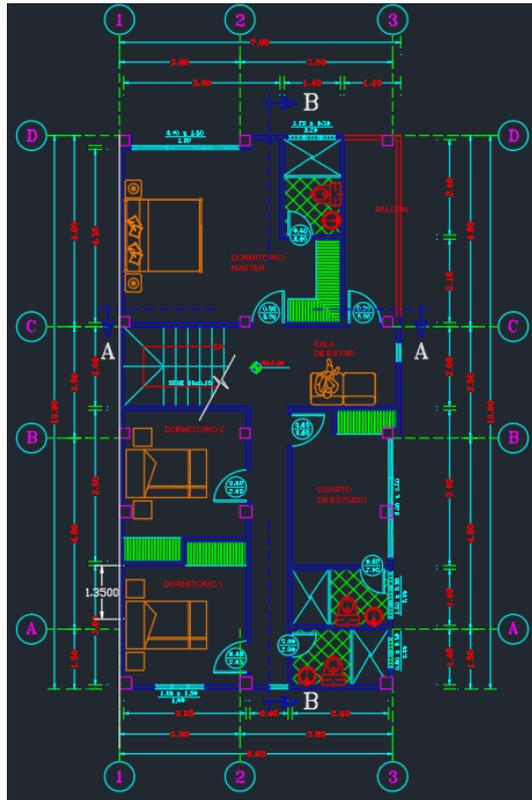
Propuesta de diseño arquitectónico, planta alta.
